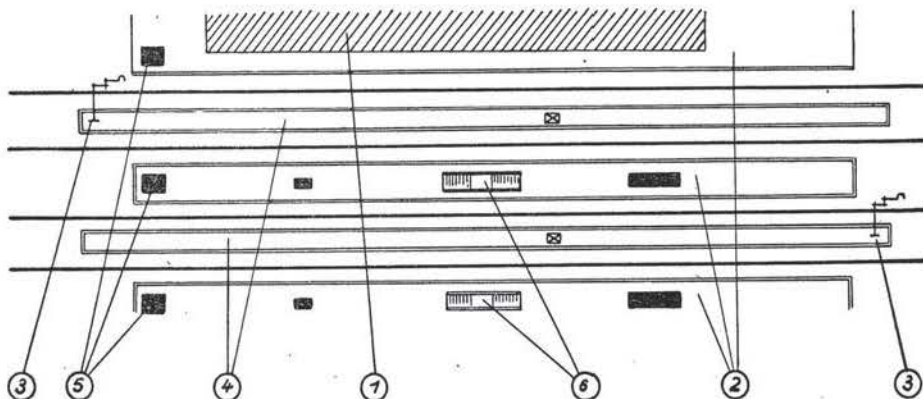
Lageplanaus-schnitt aus einem größeren Bahnhof 1 Empfangsgebäude, 2 Personenbahnsteige, 3 Wasserkran mit Gelenkausleger, 4 Ge-päckbahnsteige, 5 Aufsicht, 6 Unter-führung
